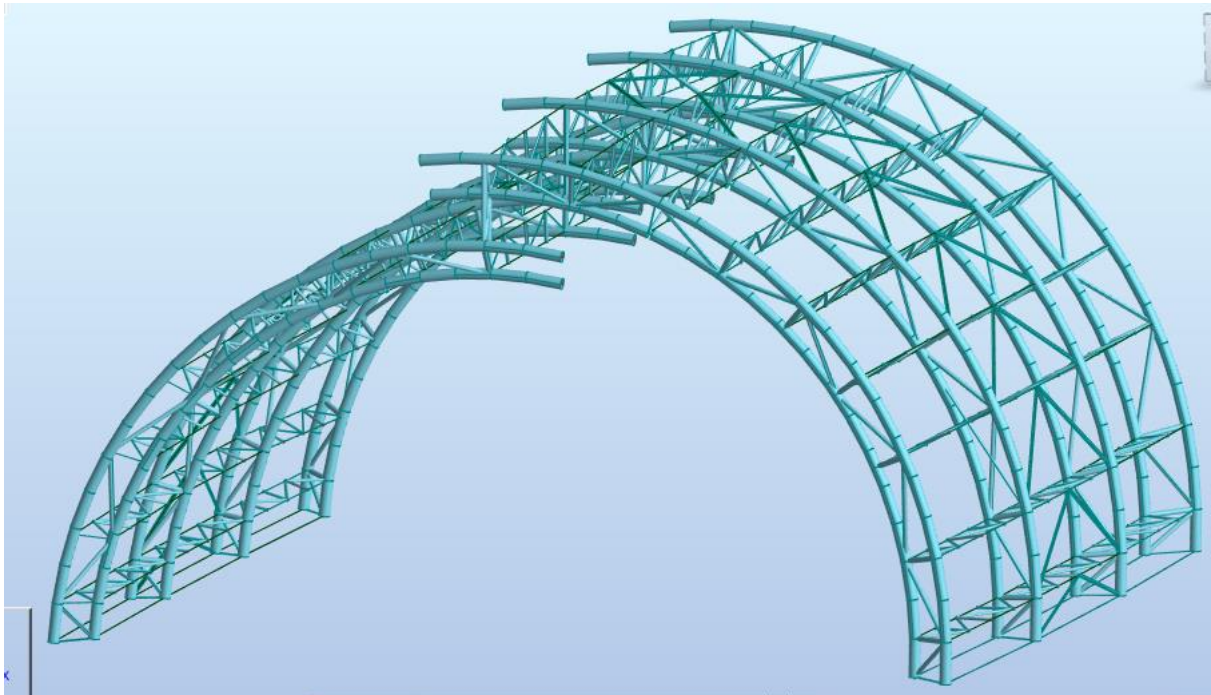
modélisation du bloc principal du treillis plan sur Robot
